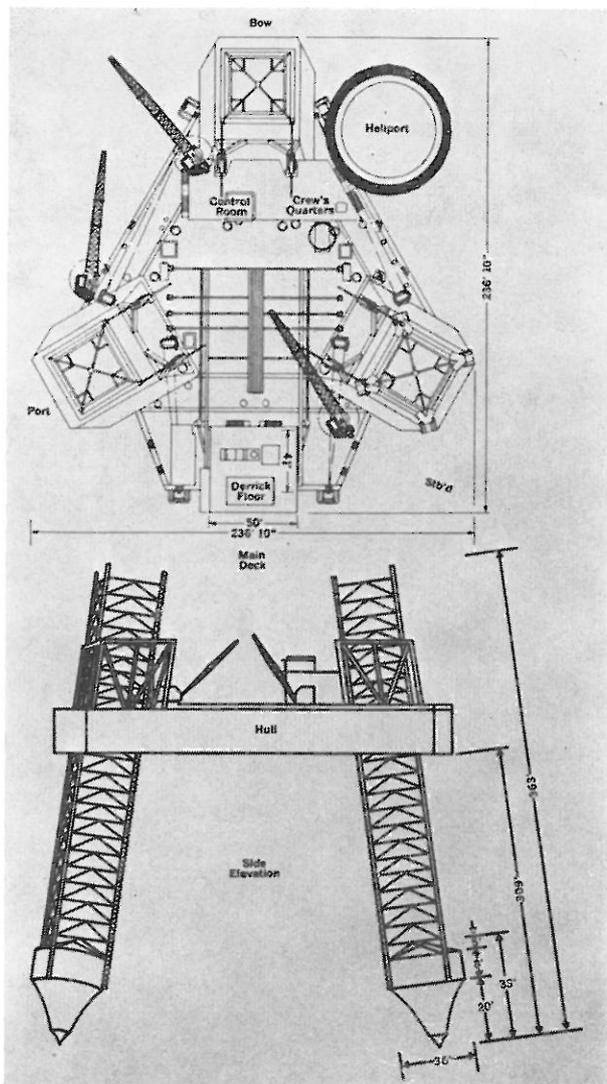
Schéma de principe des piles et du ponton de la même plate-forme auto-élévatrice avec dimensions principales en pieds.
